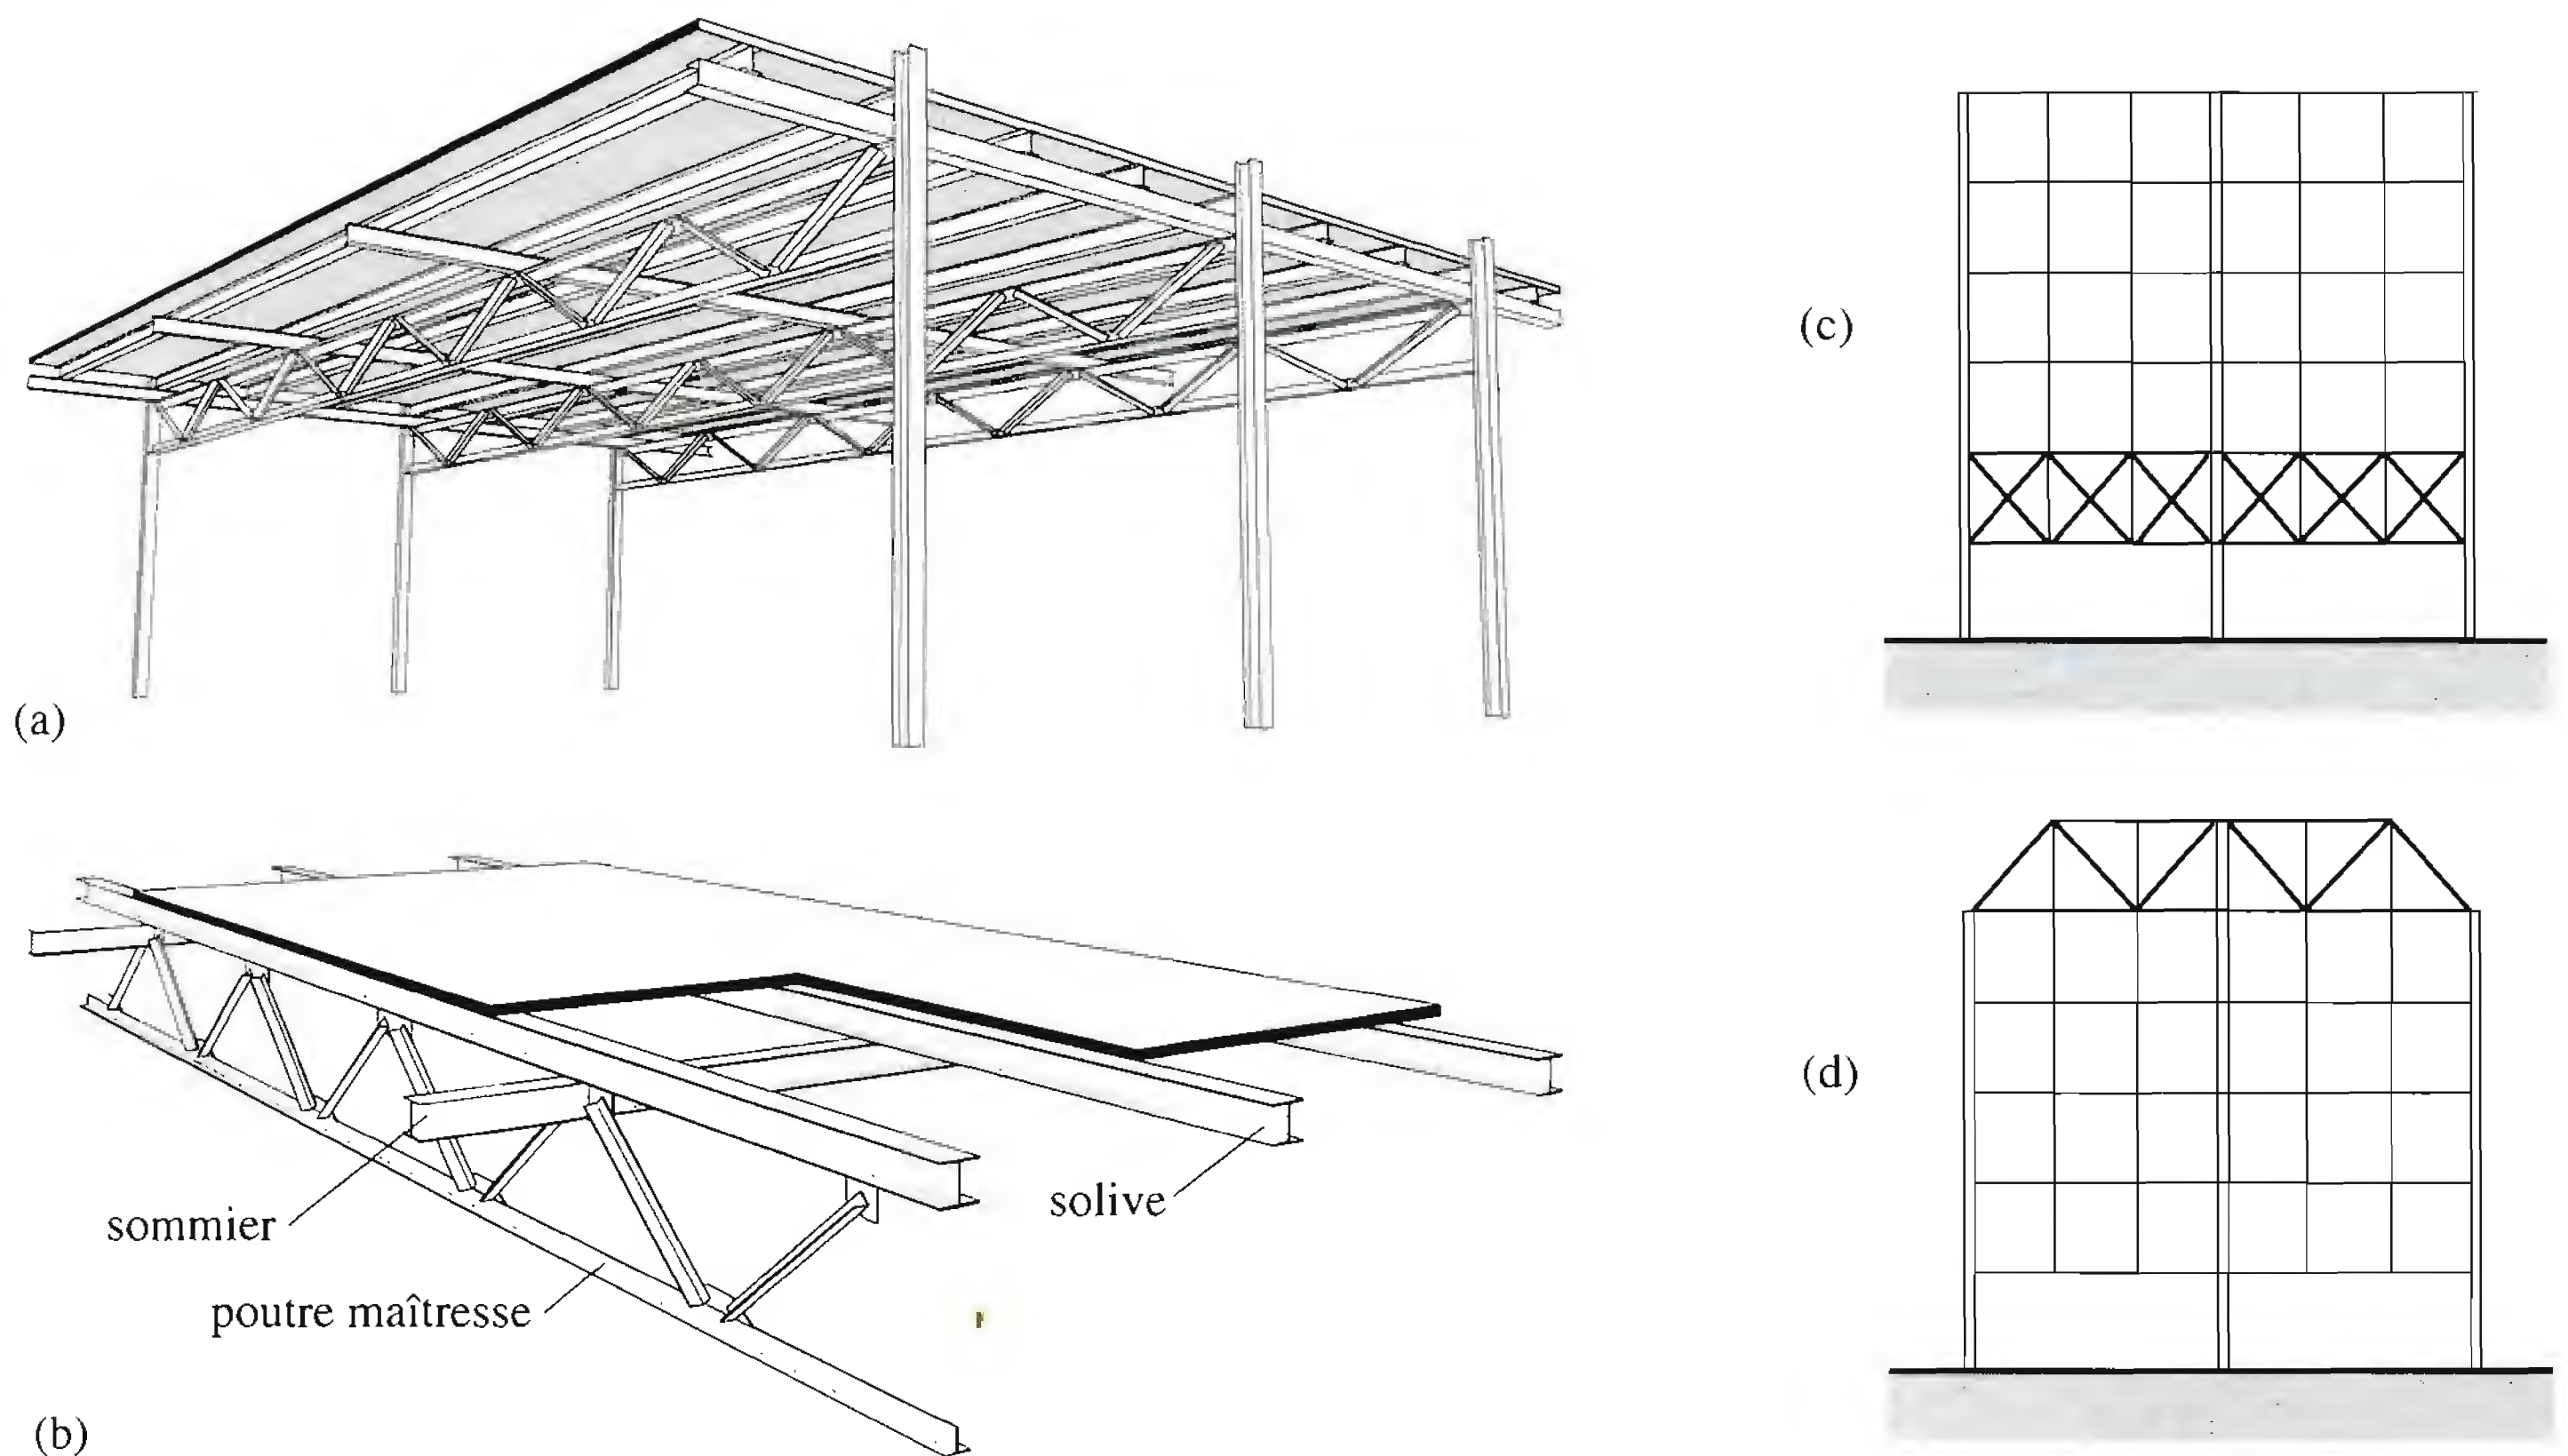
Planchers à trois niveaux de poutres (tiré de [4.1]).
